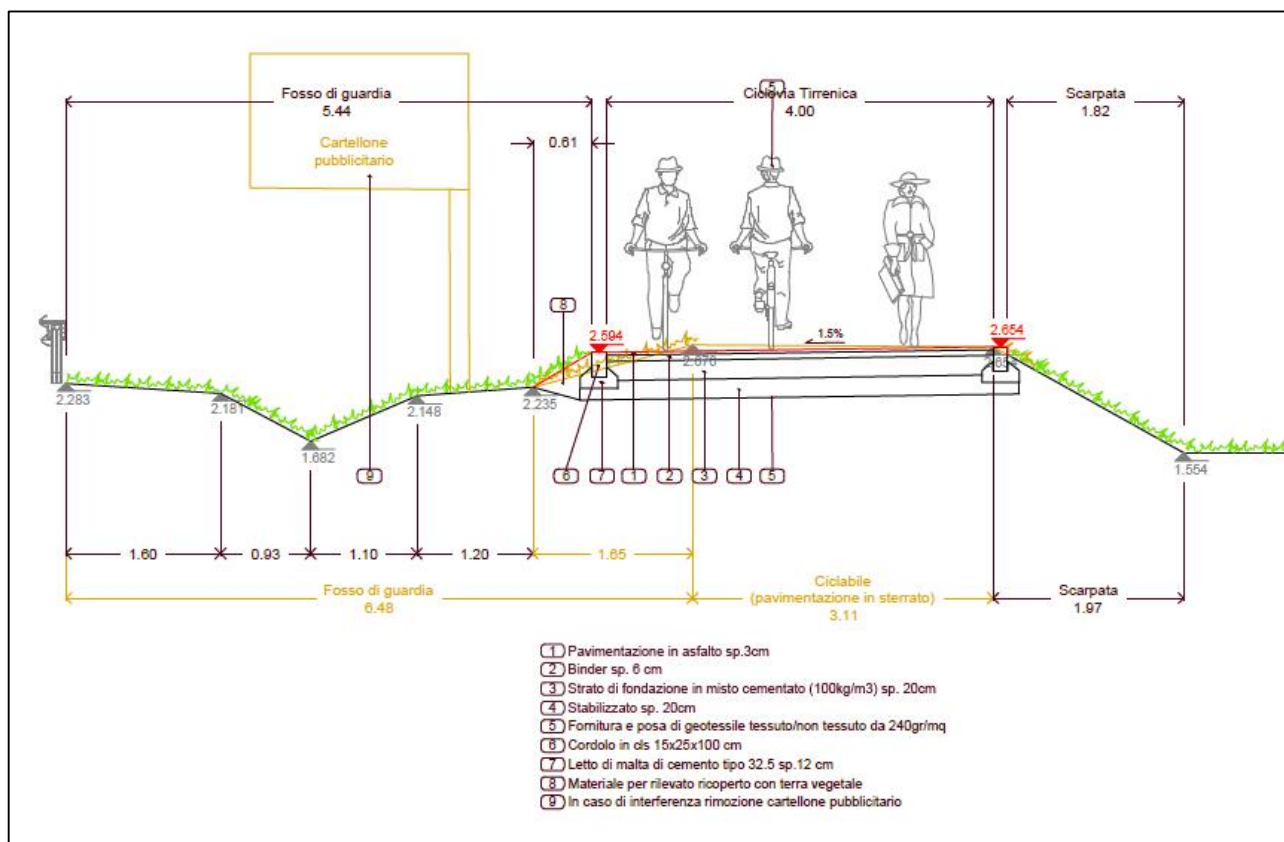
Sezione 21 di progetto trasversale SP delle Collacchie
